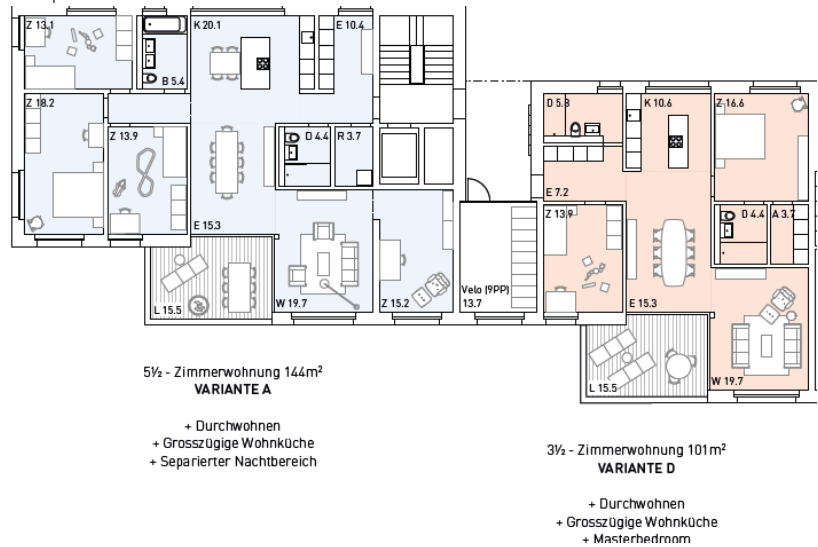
Beispiel Grundrisse Zugangsgeschoss im Haus B
